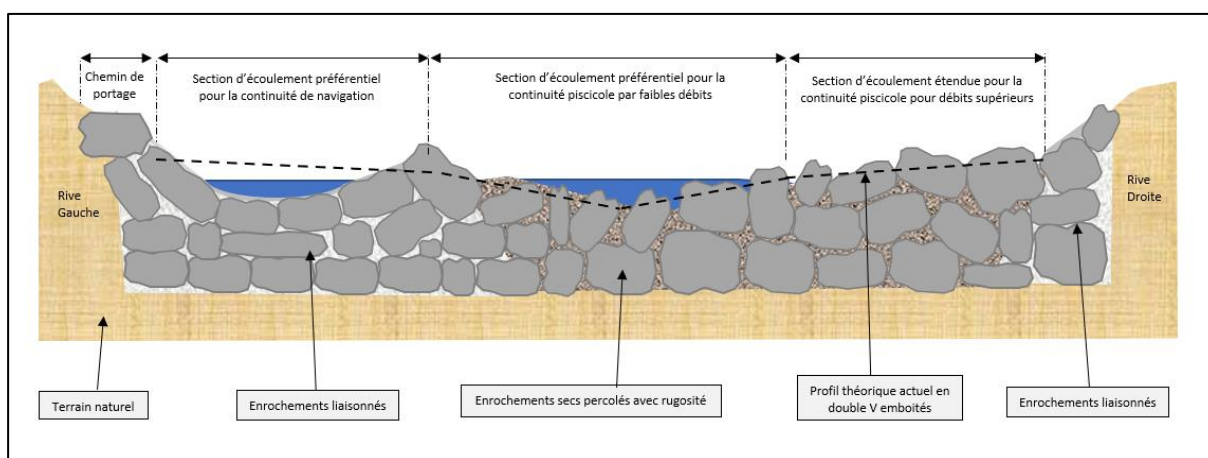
coupe schématique de l'implantation du chenal préférentiel pour la navigation et de la rampe piscicole
